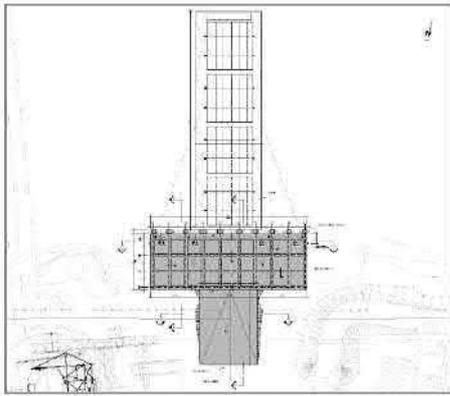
Planimetria generale impalcato pontile CP1 Calabria (el.CZ0056_F0)
